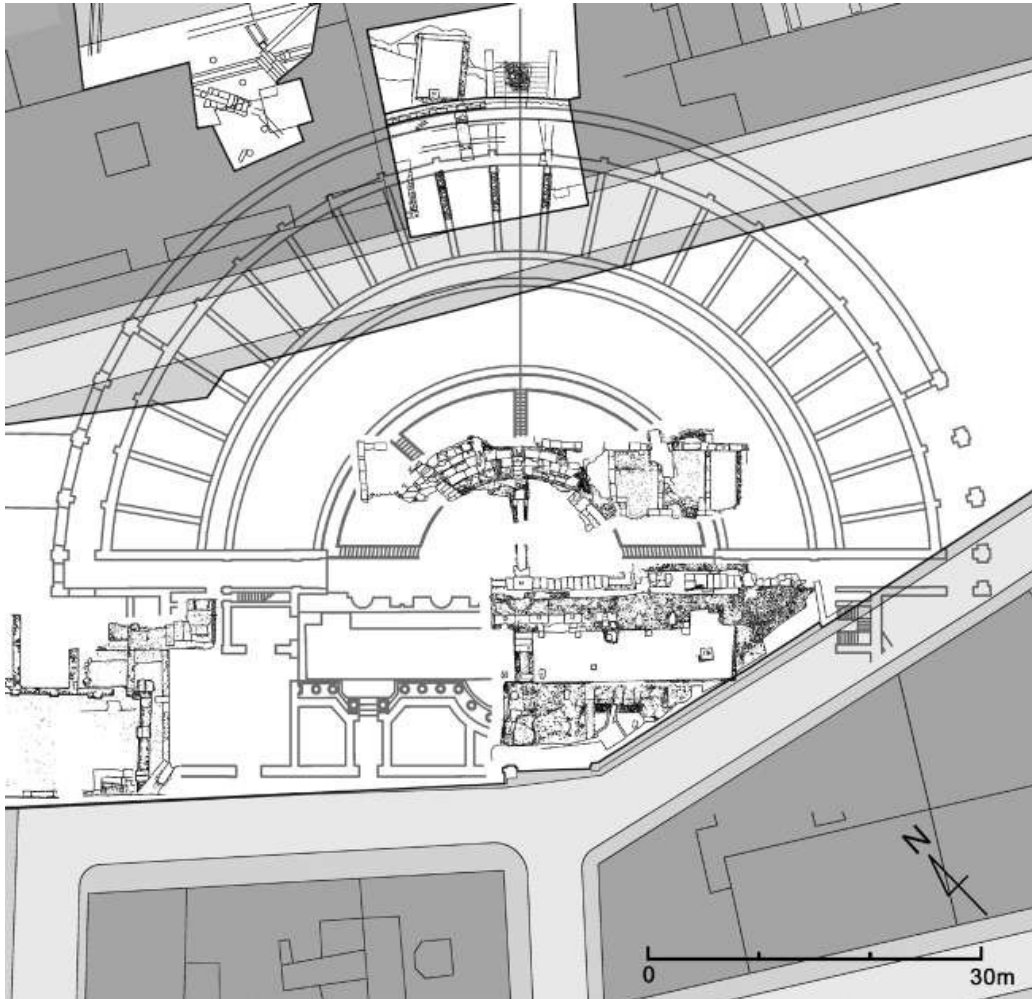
Planta reconstruida del teatro romano construido aprovechando la pendiente natural junto a la vaguada portuaria. Planta de Ricardo Mar.
